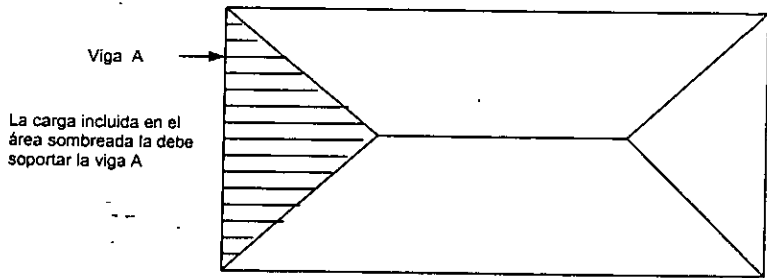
Carga aproximada tomada por las vigas de apoyo en una losa armada en dos direcciones.
